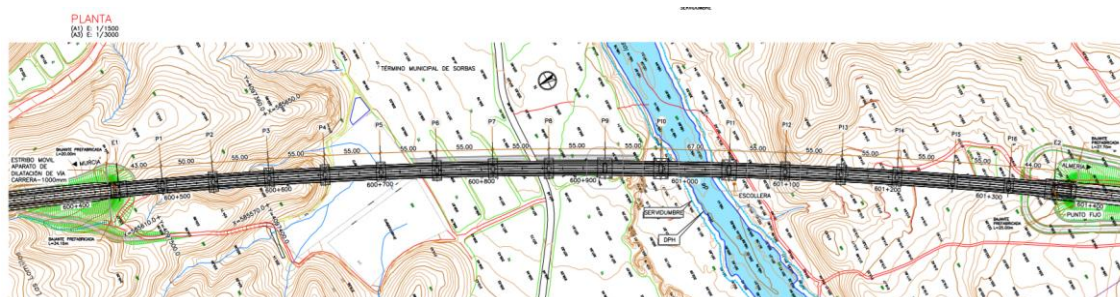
Planta del viaducto. Fuente: Proyecto de construcción de plataforma del corredor mediterráneo de Alta Velocidad Murcia – Almería.
